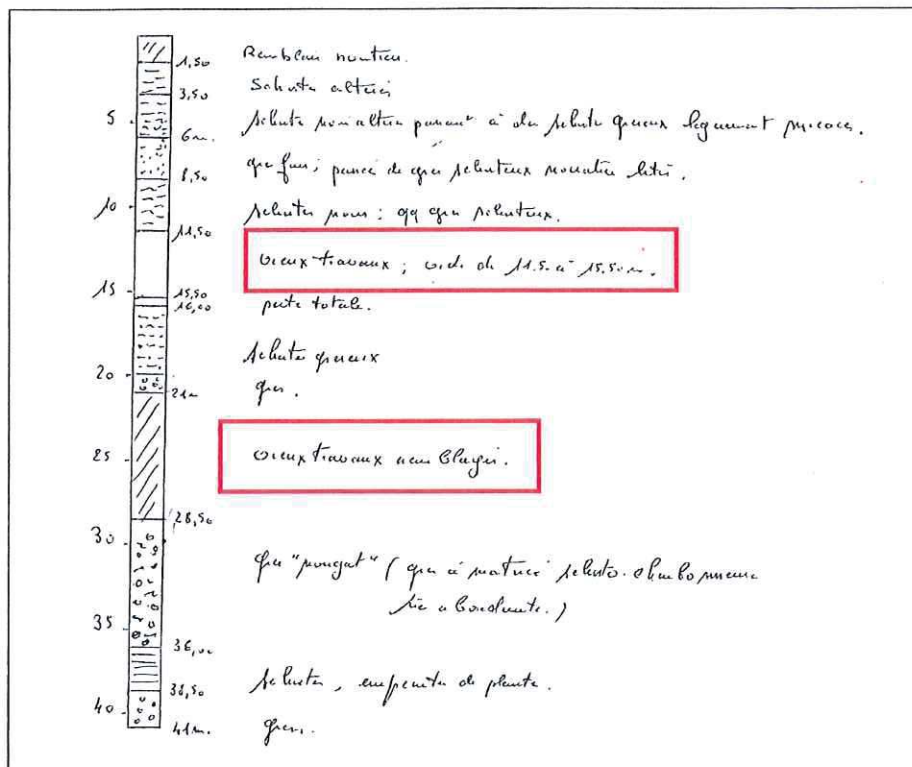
Coupe du sondage du puits Nord (Debriette, 2003)
